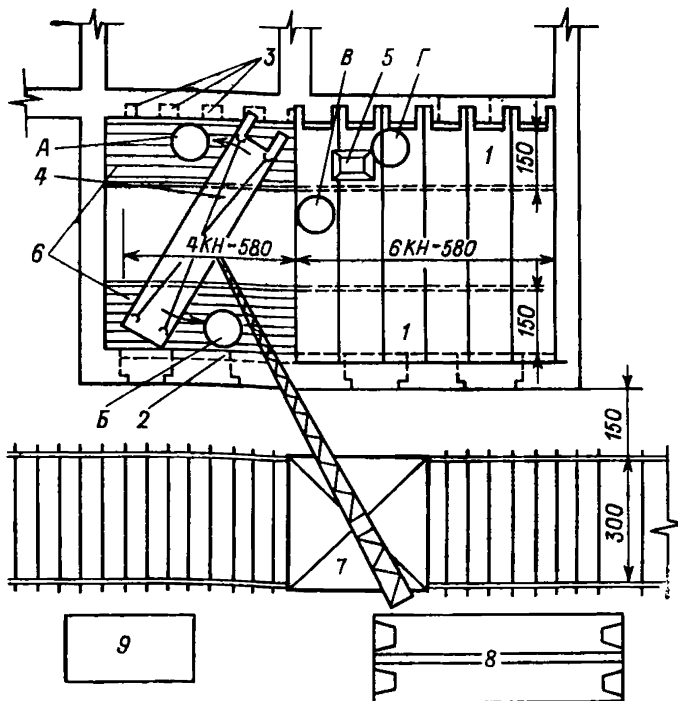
Схема организации работ по монтажу участка перекрытия из железобетонных пустотных настилов с выпускными консолями
